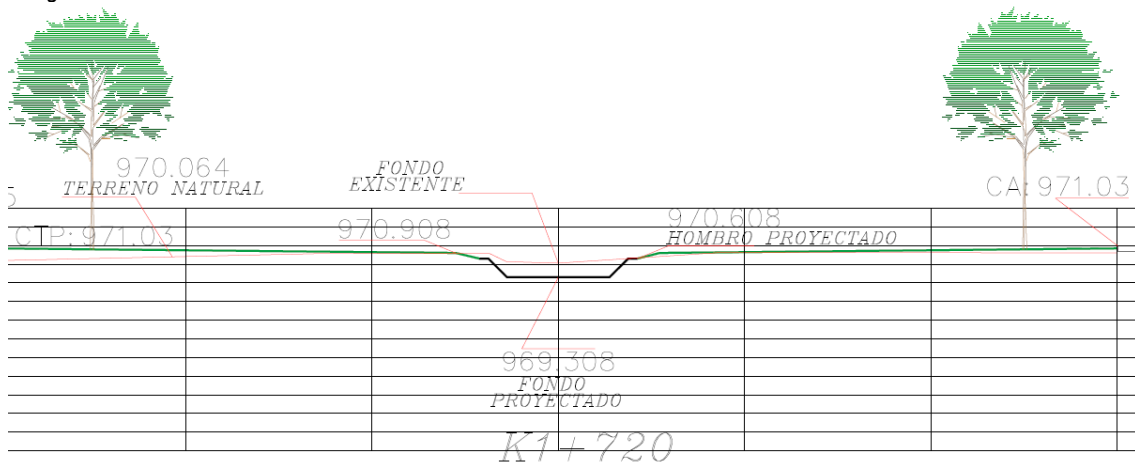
Corte transversal en la abscisa K 1+720. Donde se encuentra ubicado el Box Culvert 1, sobre la Calle 8A, la sección transversal debería presentar esta estructura.
